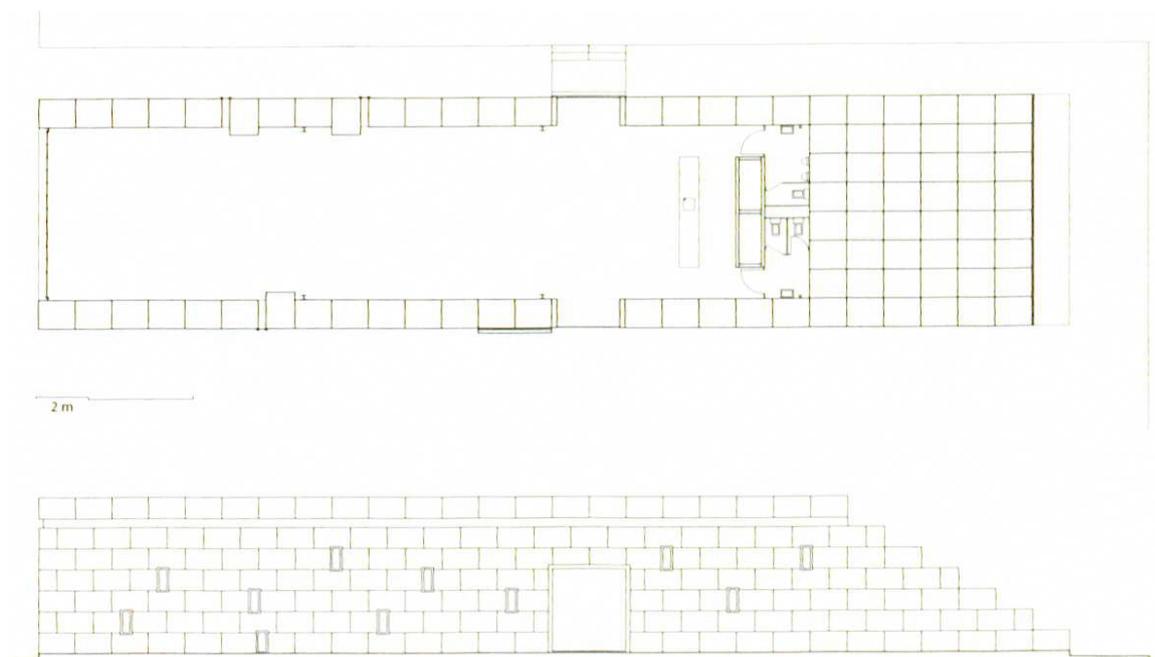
PHZ2 Grundriss und Schnitt [35]
